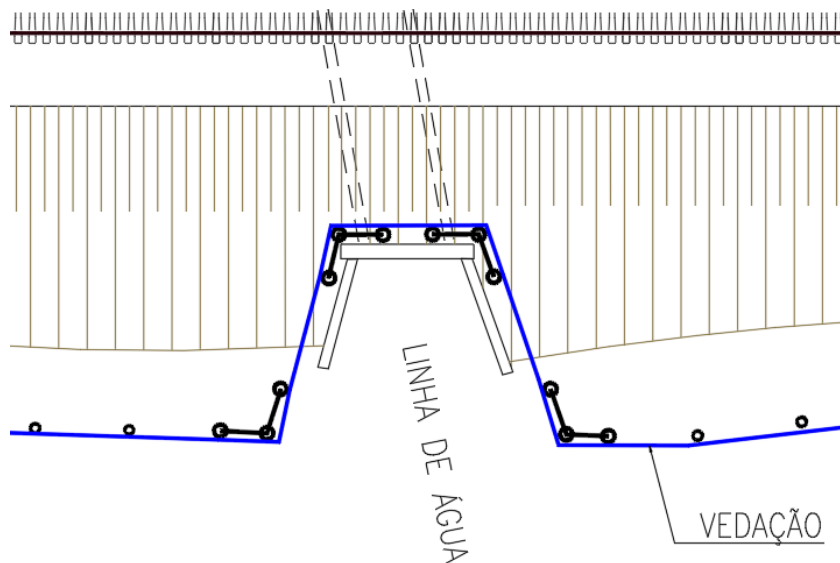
Planta de Vedação – zona das passagens hidráulicas
